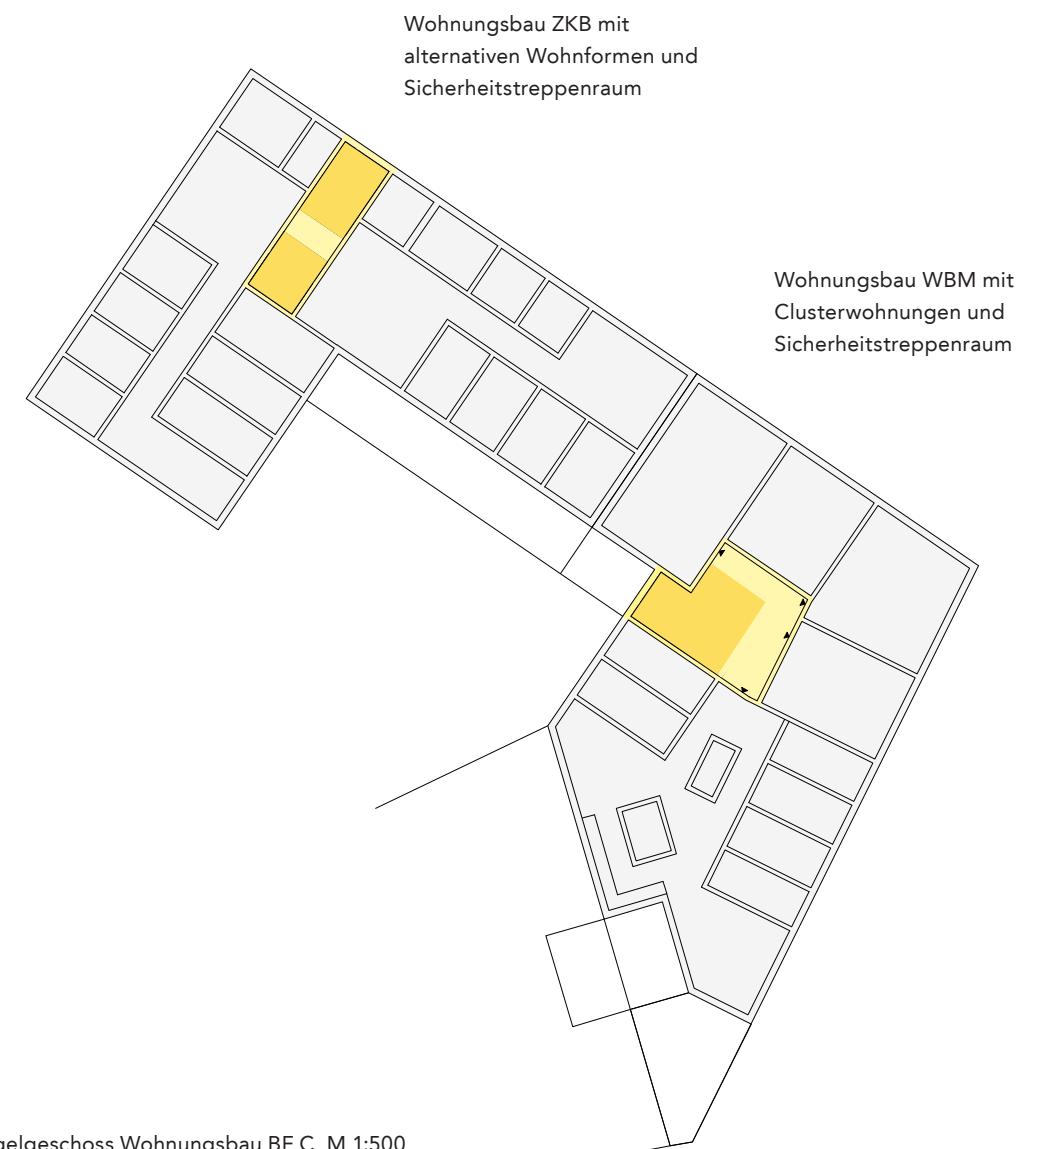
Exemplarisches Regelgeschoss Wohnungsbau BF C, M 1:500
